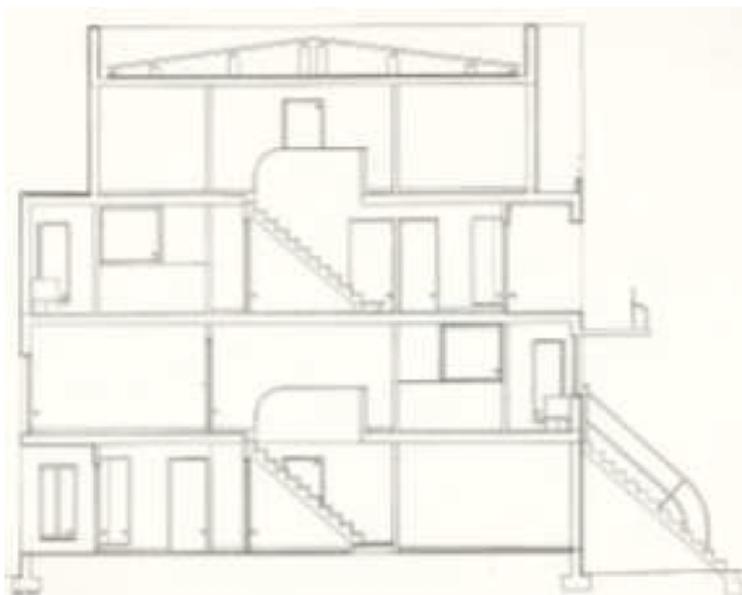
Corte transversal do bloco habitacional da Bouça.
